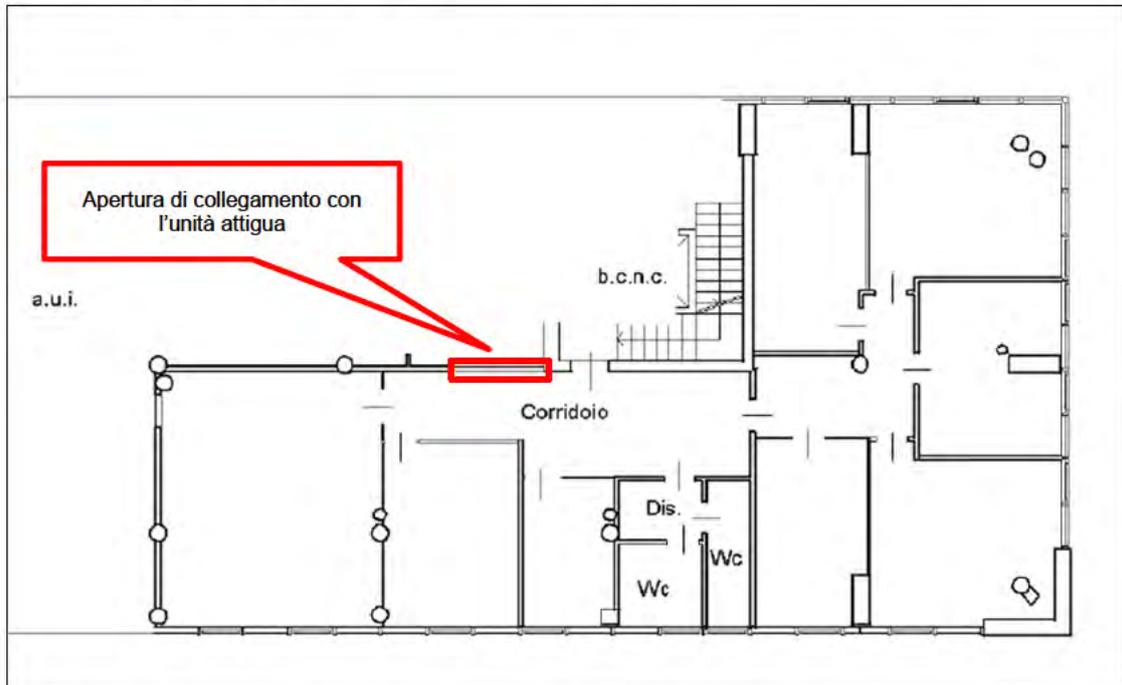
planimetria catastale dell'ufficio identificato con la particella 34 sub 40 con evidenziata la difformità rilevata:
